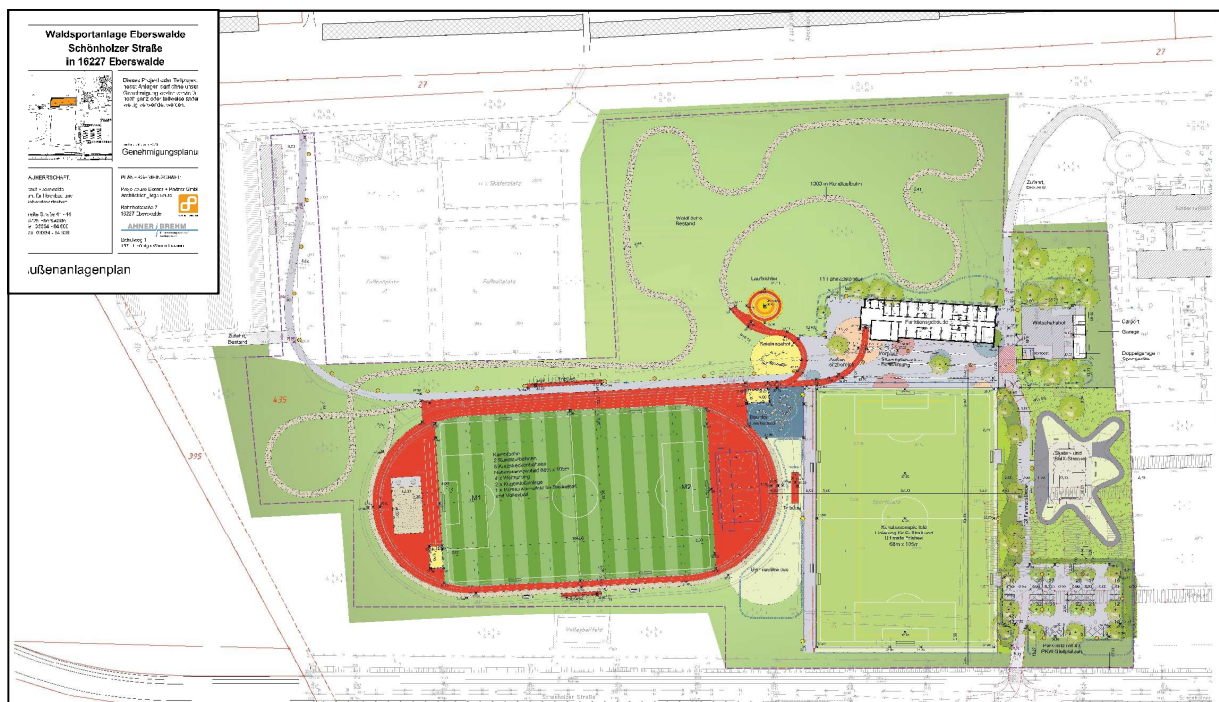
beschlossene Entwurfsplanung zur Waldsportanlage Finow“ (Anlage 4 zur Beschlussvorlage BV/0573/2017 - Zusatzvariante Waldsportanlage – Genehmigung der Entwurfsplanung und Baubeschluss)
